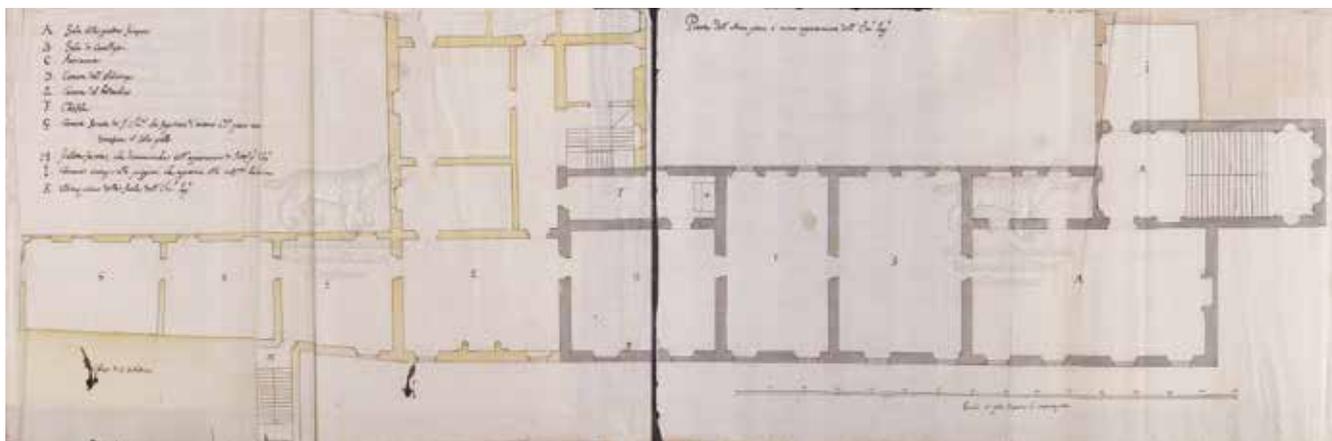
C.47 - BANLC, CORS. 34K-2, c. 29rB – Ravenna, Anonimo, *Pianta piano secondo del palazzo Apostolico di Ravenna*, pianta (1696ca).
